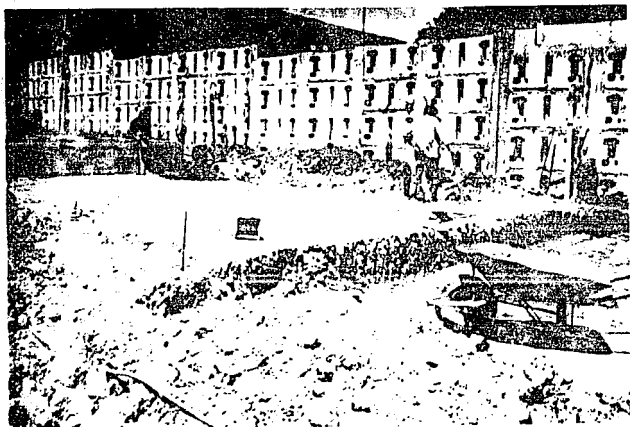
CORTE Y EXCAVACION A MANO DE
